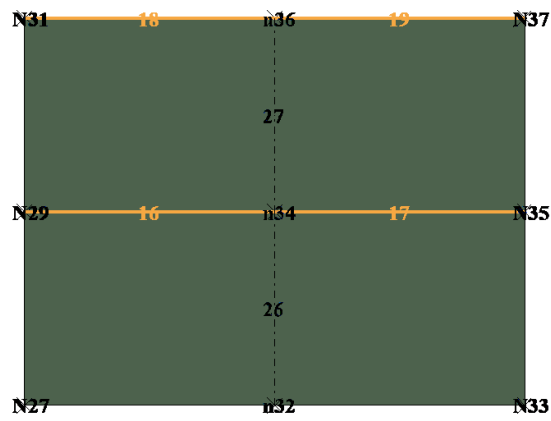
Prospetto Parete 5 - Modello Scollegato
